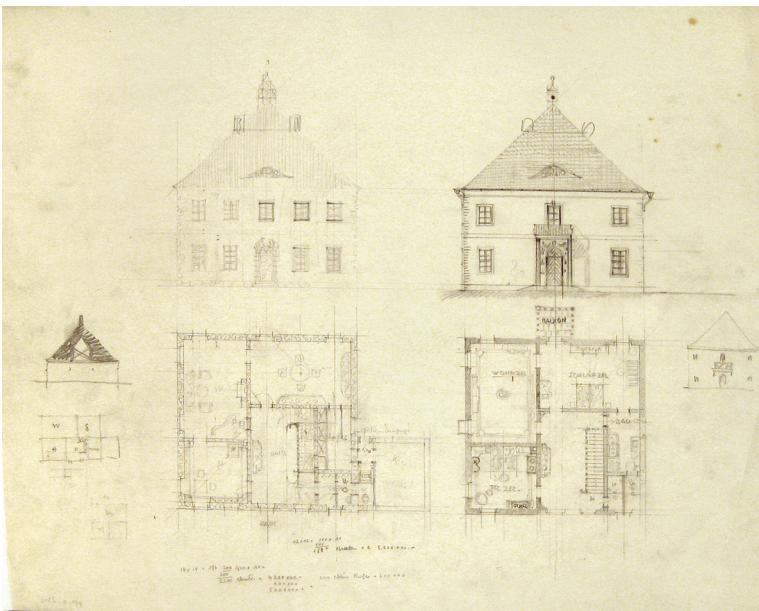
Eduard Pfeiffer, Entwürfe für zwei benachbarte Einfamilienhäuser, 1922, Aufrisse und Grundrisse.
